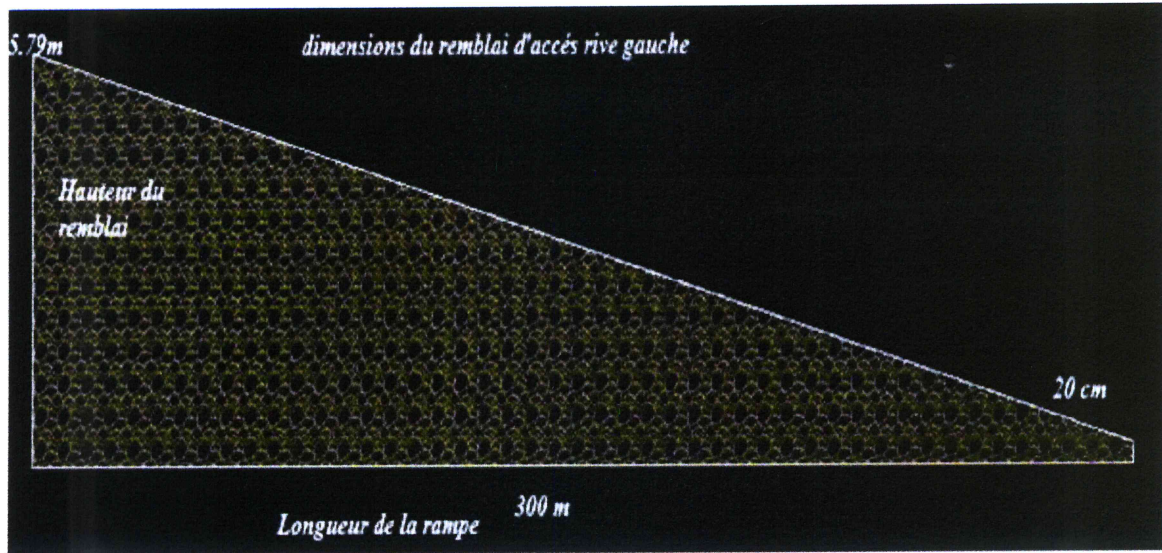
Coupe longitudinale du remblai du rive gauche
